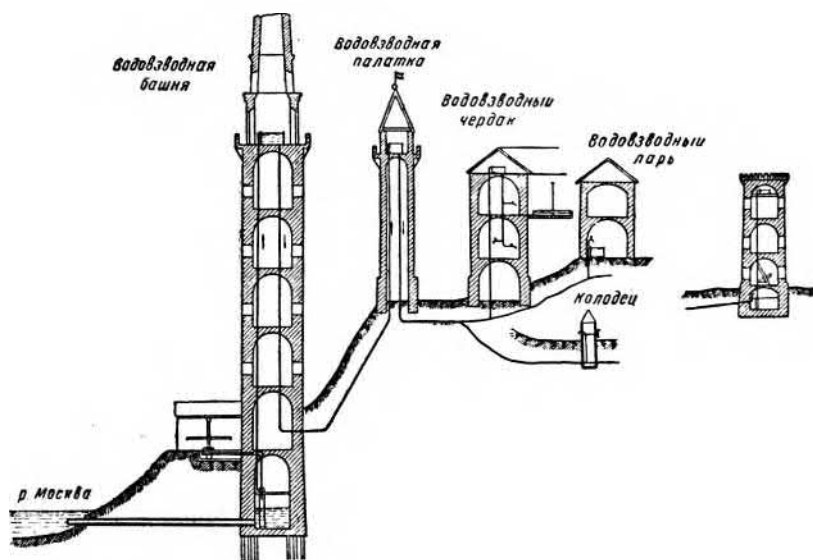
Схема напорного водопровода в Кремле (реконструкция).
